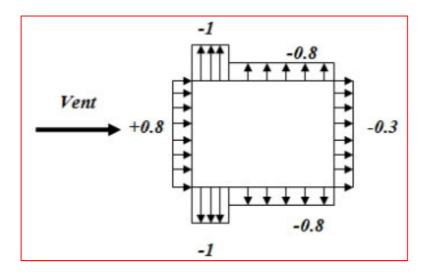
/ Cpe pour les parois verticales de bâtiment à bas rectangulaire
